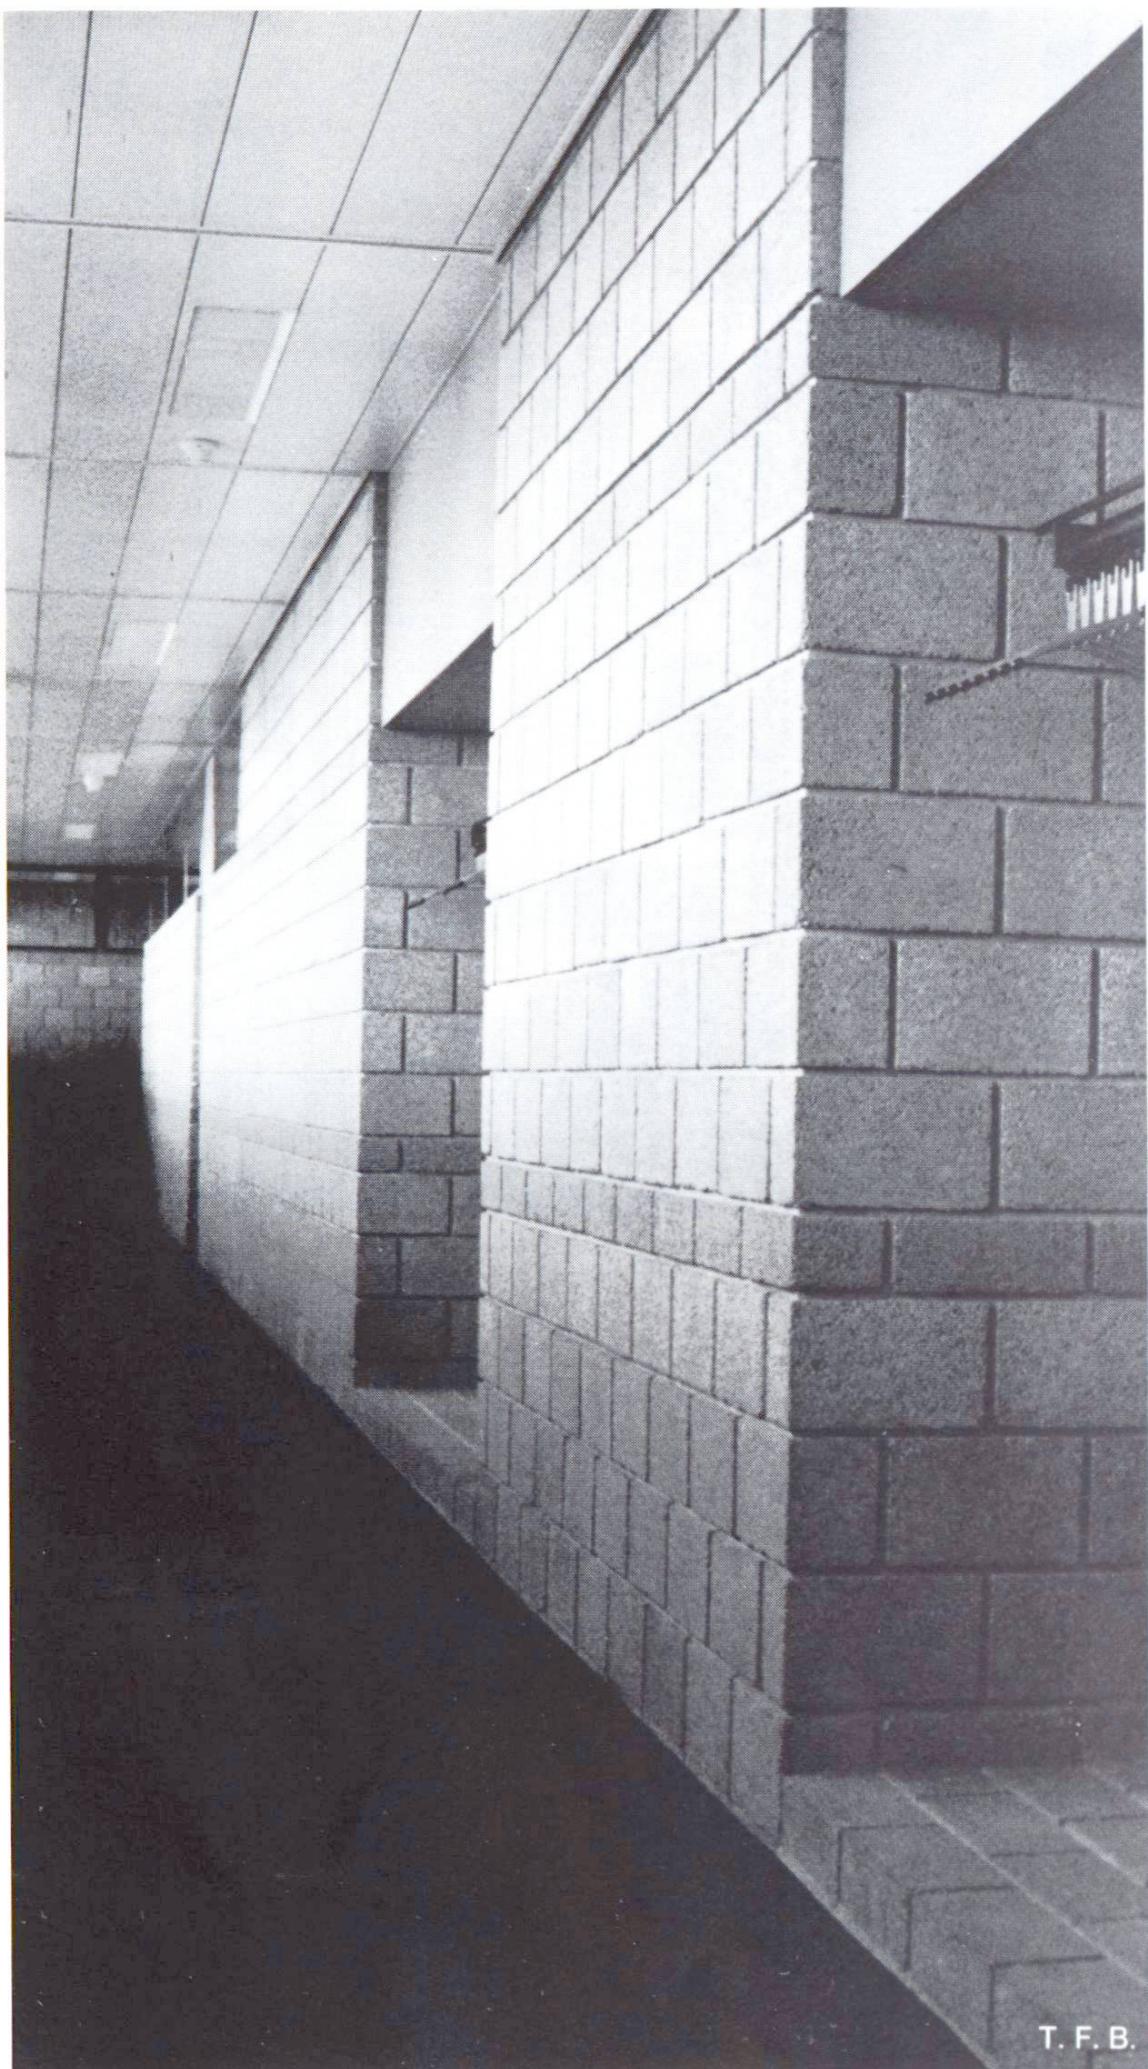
Beton-Sichtmauerwerk in Kombination mit einfacher Holzkonstruktion.
